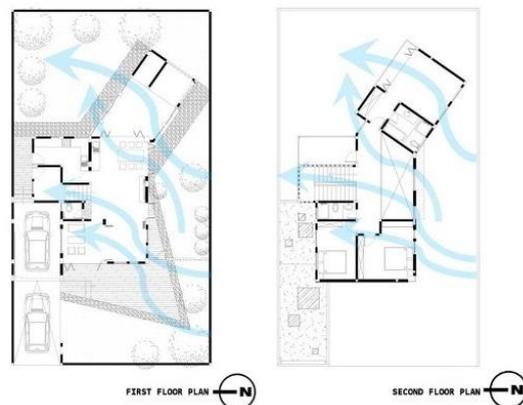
Planta baixa que enfatiza a estratégia de ventilação cruzada.
